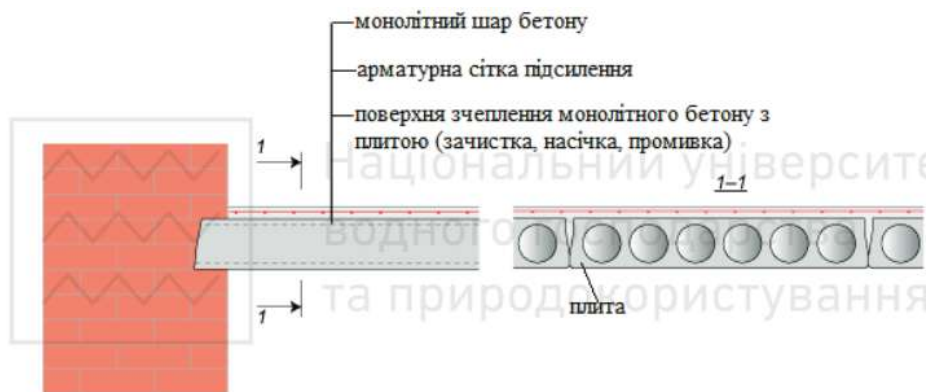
Метод підсилення багатопустотної плити шляхом нарощення зверху, забезпечуючи зчеплення поверхонь
